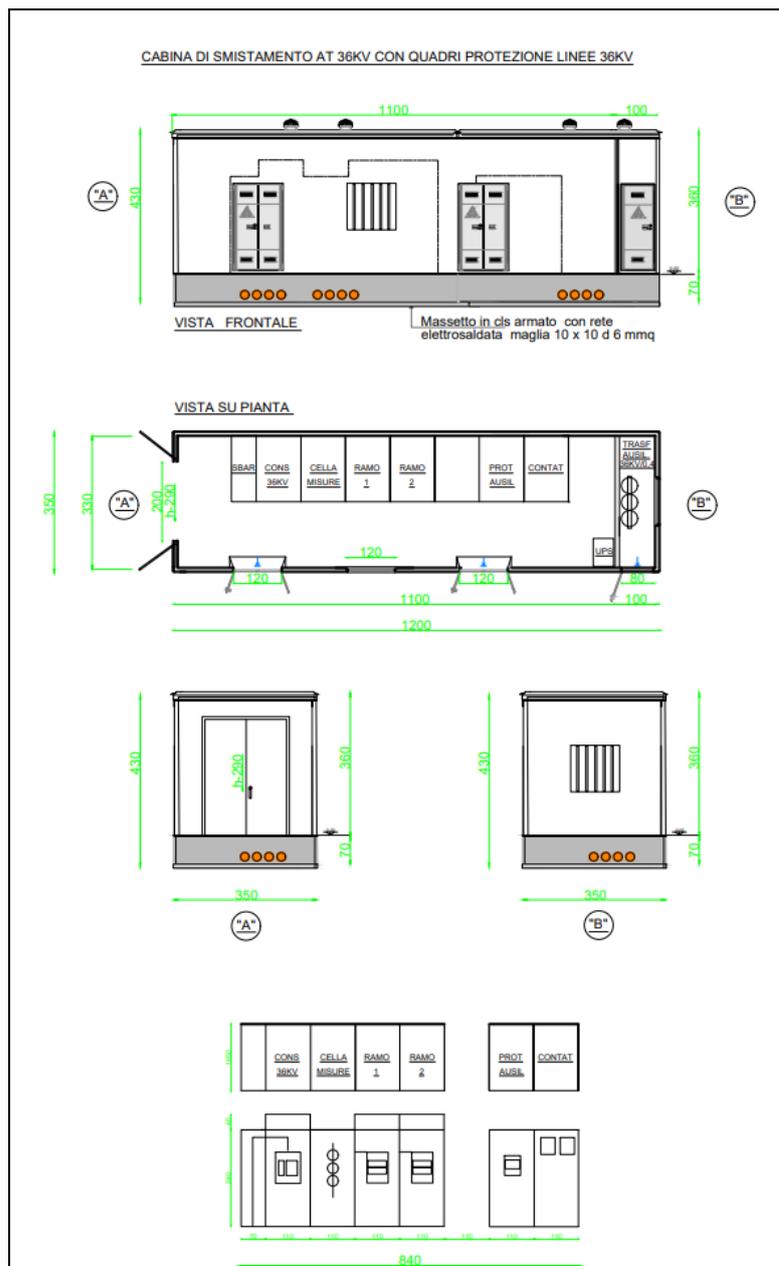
Viste planimetriche e in prospettiva della cabina di smistamento
